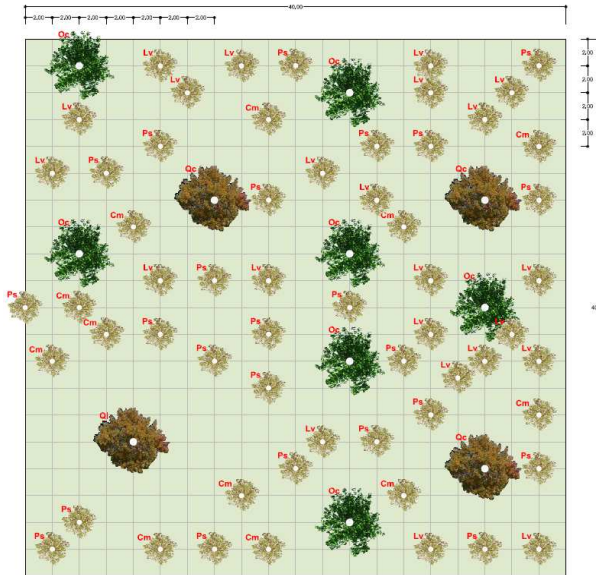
Stralcio planimetrico delle opere di mitigazione ambientale
